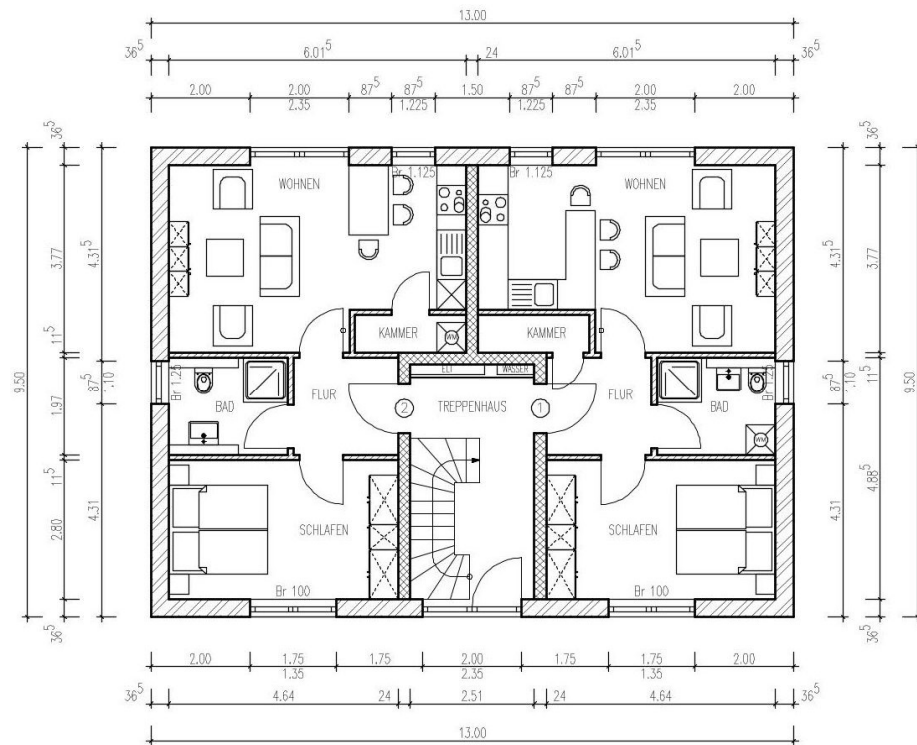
Wohnzimmer mit Küche Dachgeschoss\
